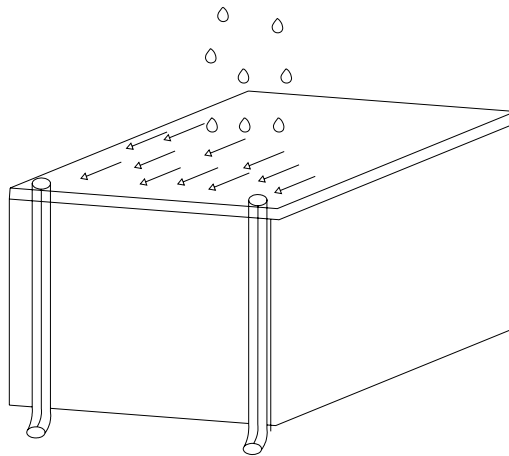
Esquema de losa nivelada con bajadas.
